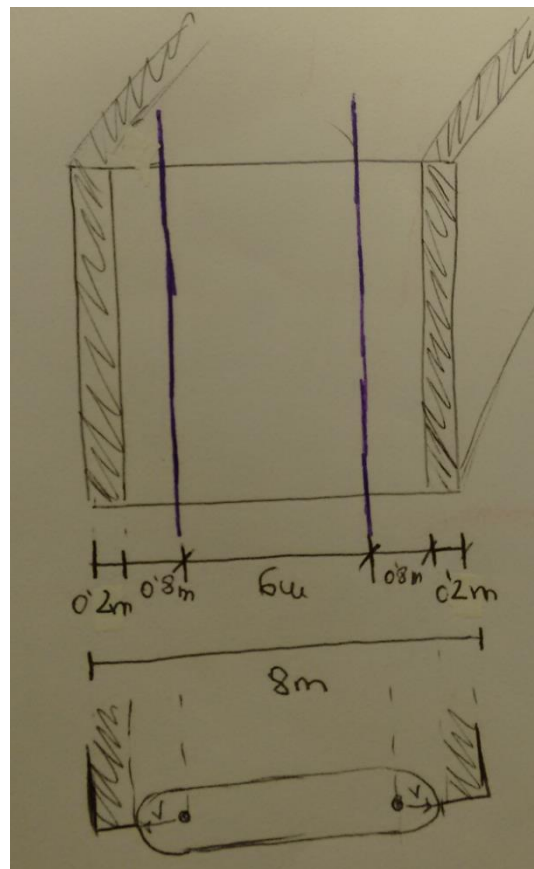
Croquis de la sección de la pila (Fuente: Fotografía propia)
